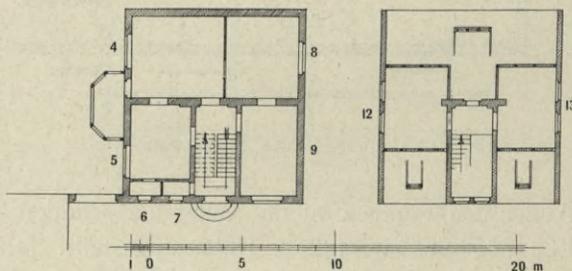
Grundrisse des Erdgeschosses und Dachgeschosses vom Maschinistenwohnhaus.
